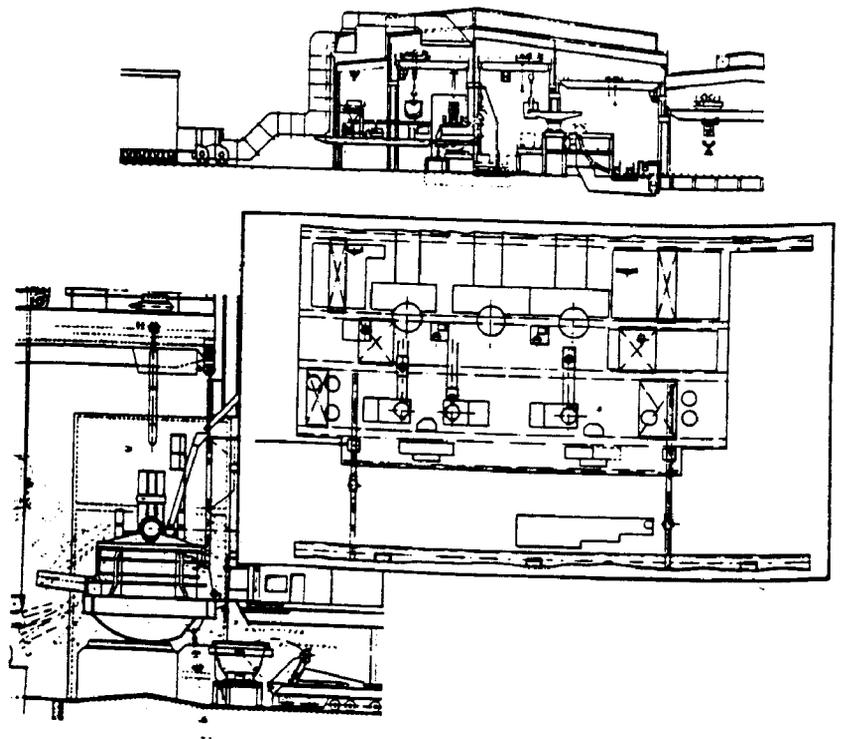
Layoutzeichnungen aus dem Bereich der Hüttentechnik (Ausschnitte)
